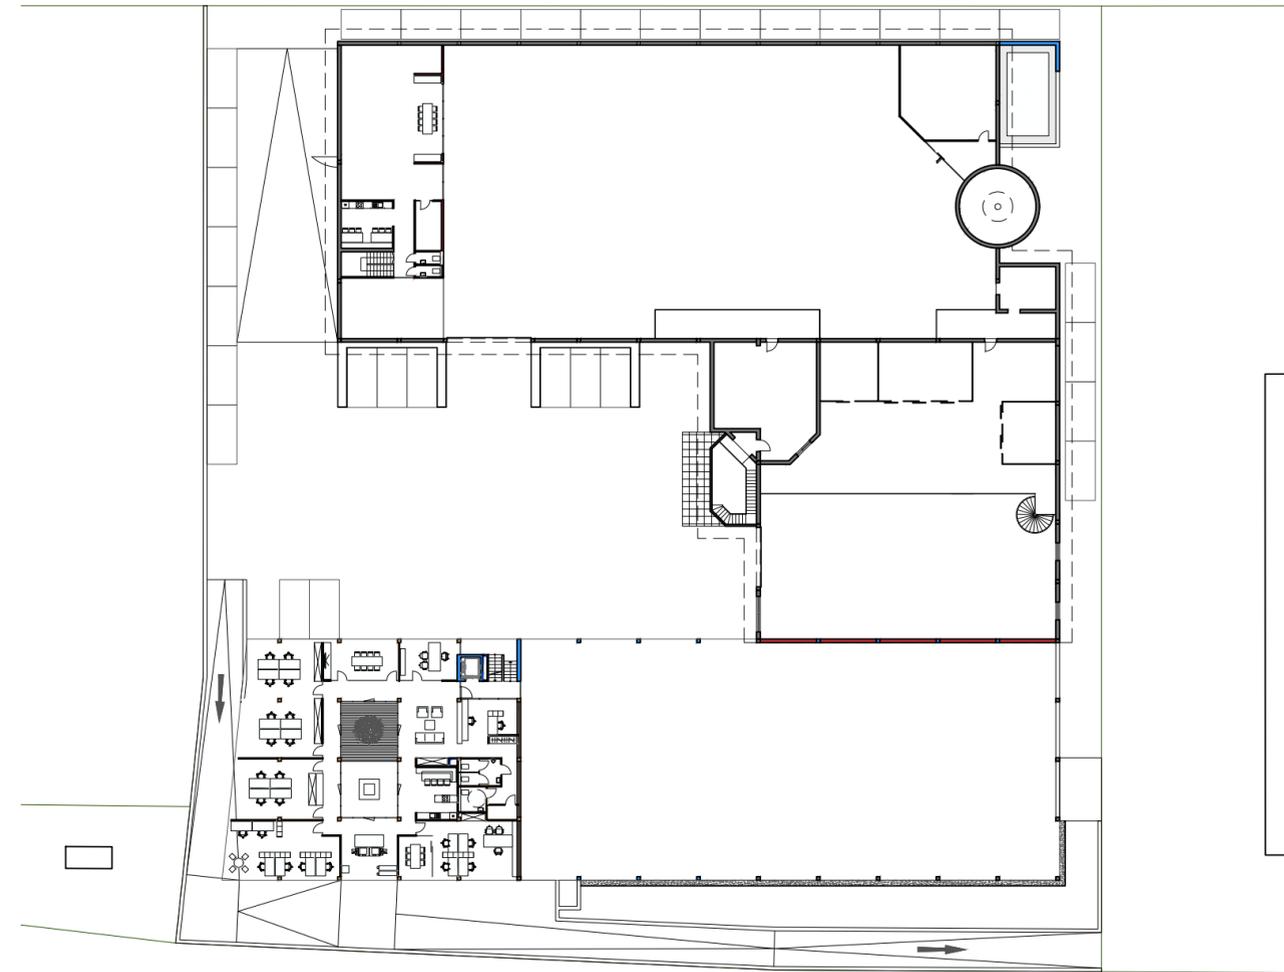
Einreichung Auswechslung - Grundriss Obergeschoß
